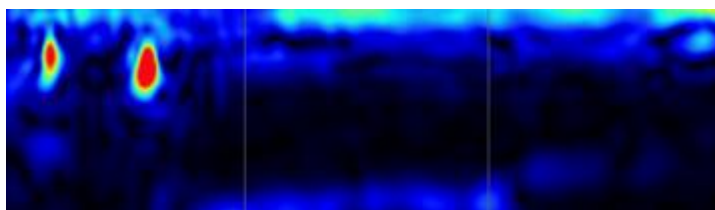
Bare de armătură longitudinală din sâmburele de beton armat C/9 identificate în peretele din axul C
